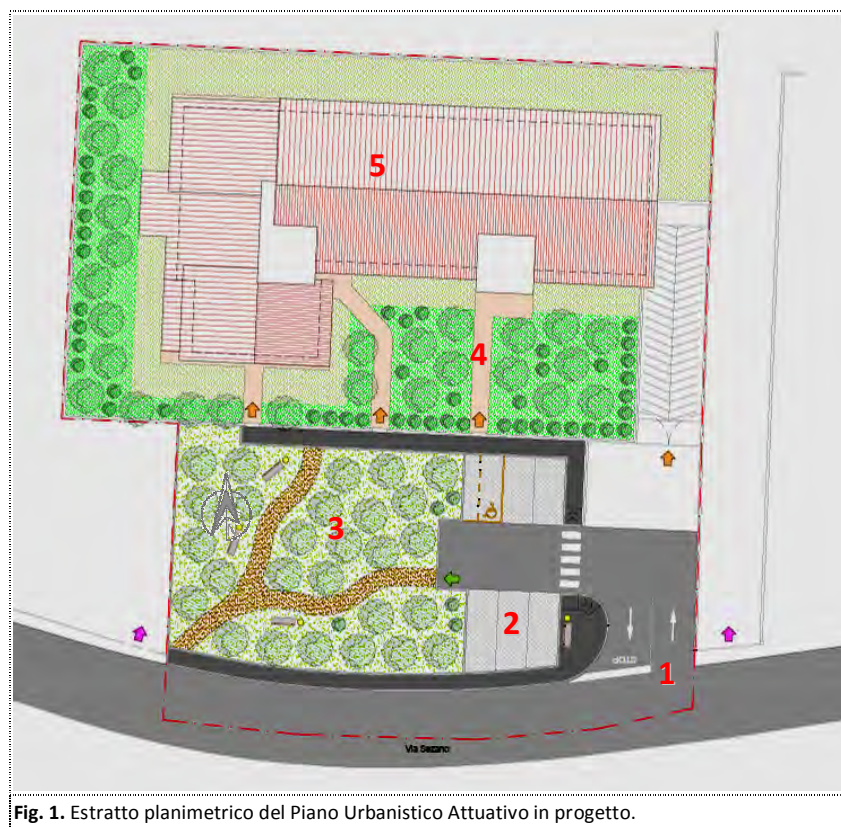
Estratto planimetrico del Piano Urbanistico Attuativo in progetto.
